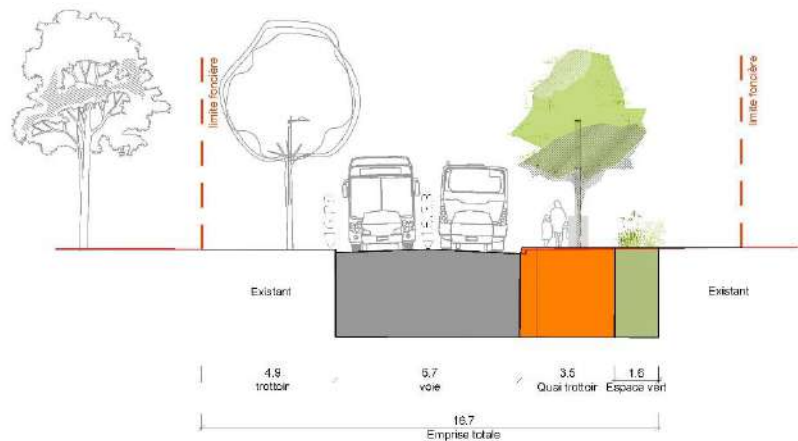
Coupe type sur l'avenue du Maréchal Juin
